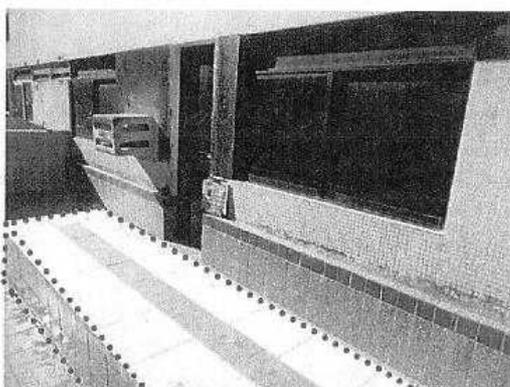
Acréscimo de área do Apto. 105: Vista de leste para oeste. Destaque da "mesa" construída sobre a laje.
